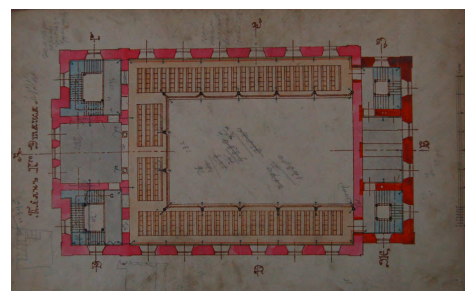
Planmaterial Grundriss 1. Geschoss
